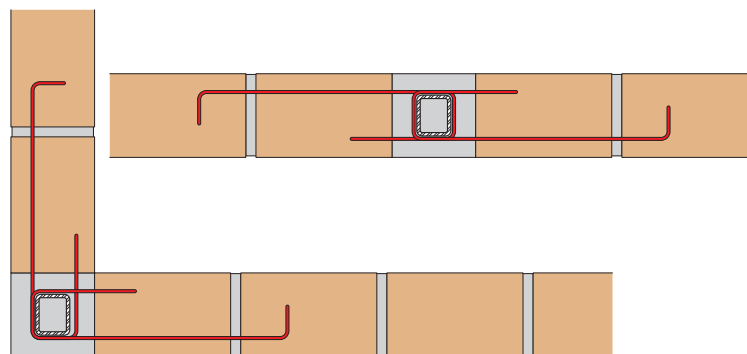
Ligações entre alvenarias e pilares de aço – estrutura embutida.
